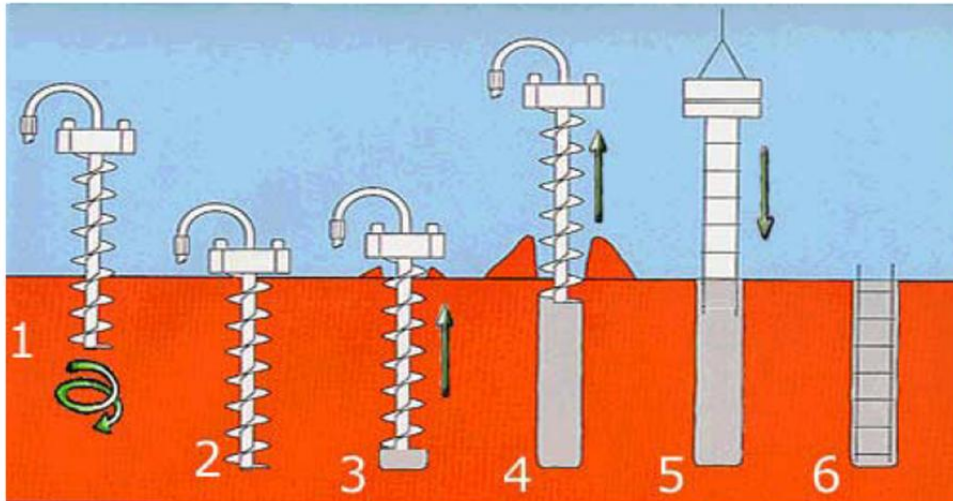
Procedimiento constructivo de pilas Starsol; 1) perforación, 2) perforación completa a profundidad de diseño, 3) inicio de la inyección del concreto, 4) inyección del concreto finalizada, 5) colocación del armado, 6) pila terminada (Briançon, 2002).
